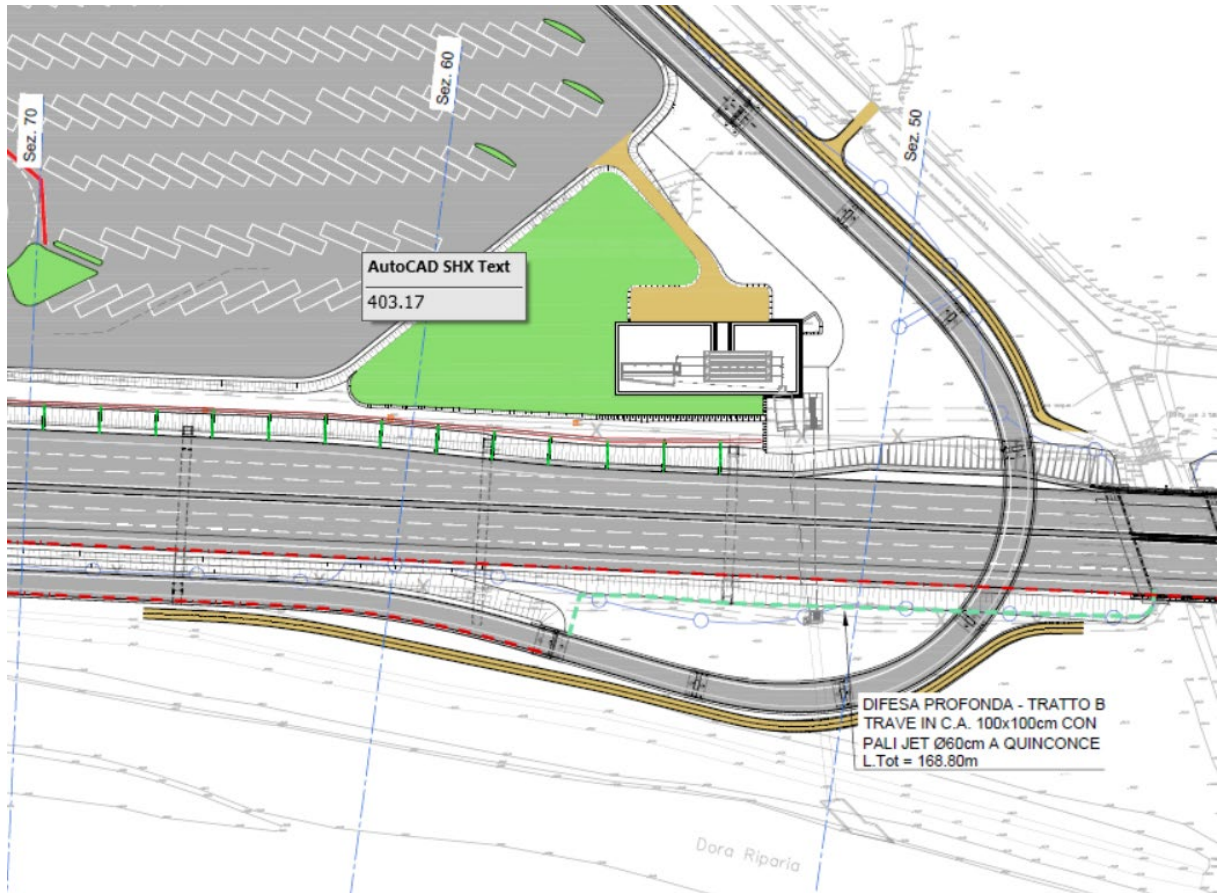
Estratto planimetrico dalla tavola tratto di valle
